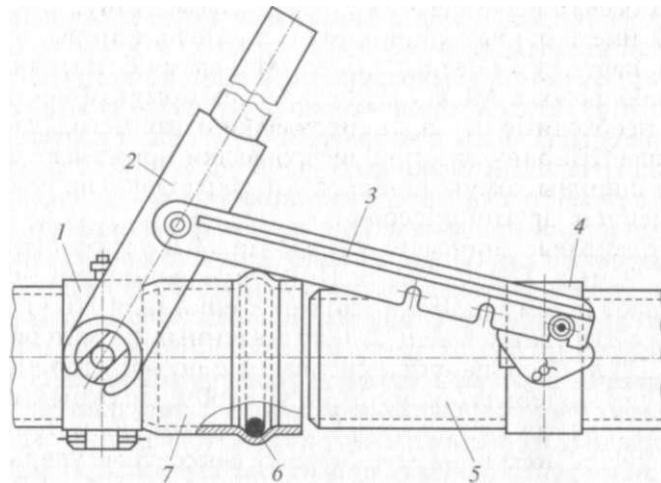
Стыковочное устройство для монтажа труб в раструбах на резиновых кольцах:
